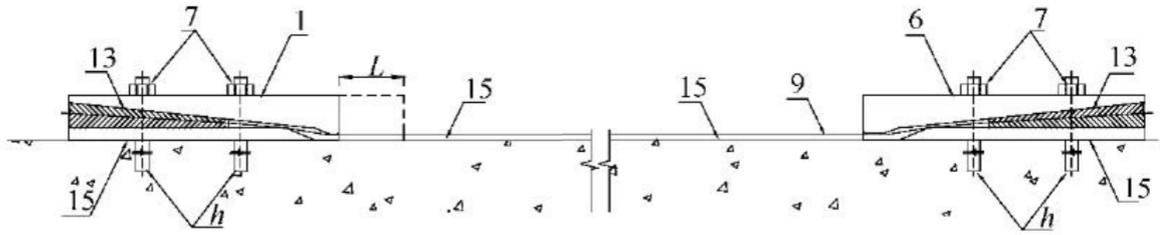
张拉完成锚具纵向剖面示意图
